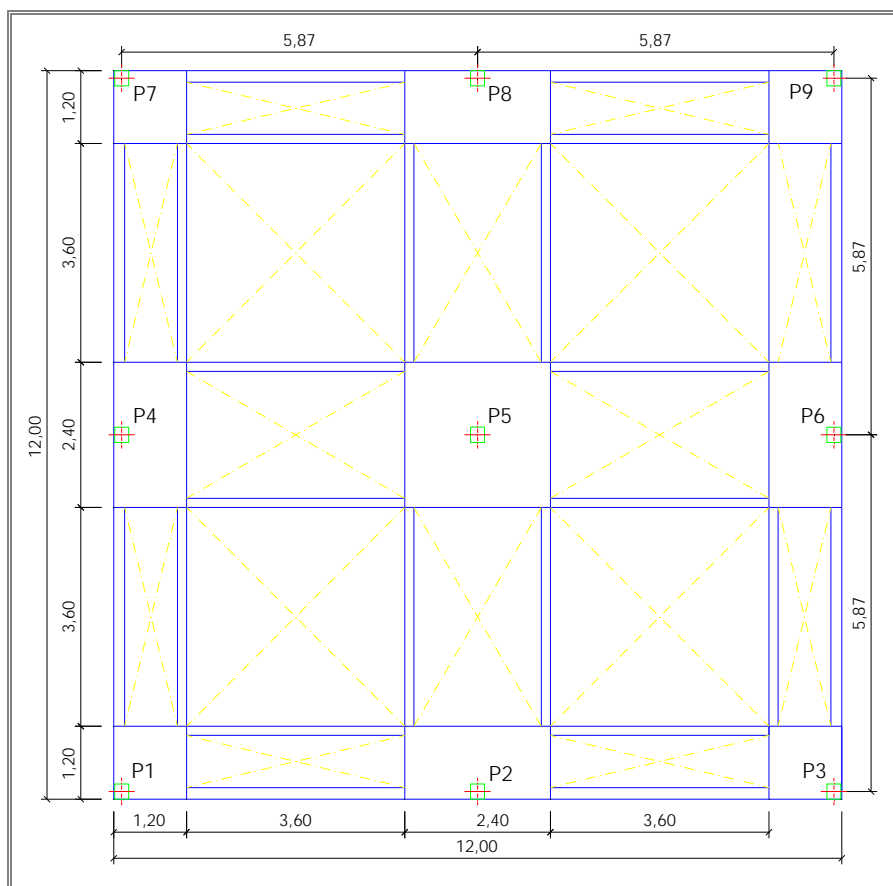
Planta acotada del modelo aligerado (cotas en cm.).
